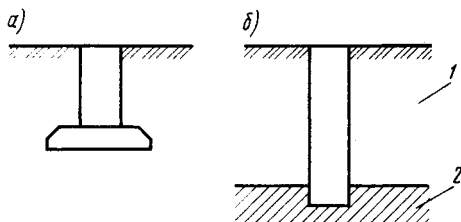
Устройство фундаментов в надежных грунтах:
